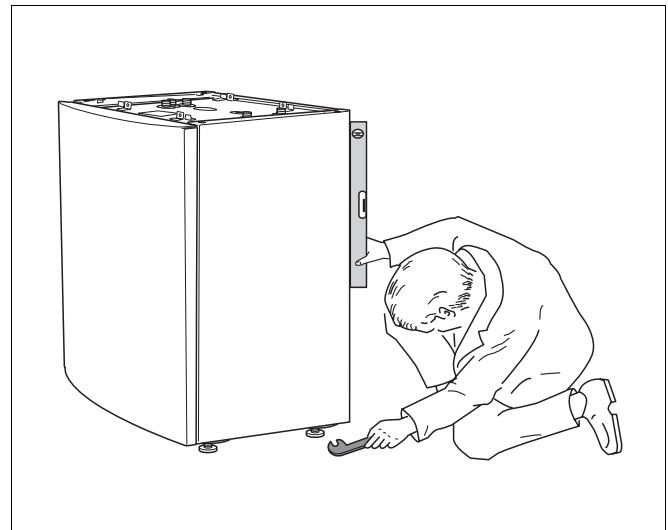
Fußschrauben justieren (Prinzipabbildung) mit Hilfe einer Wasserwaage
